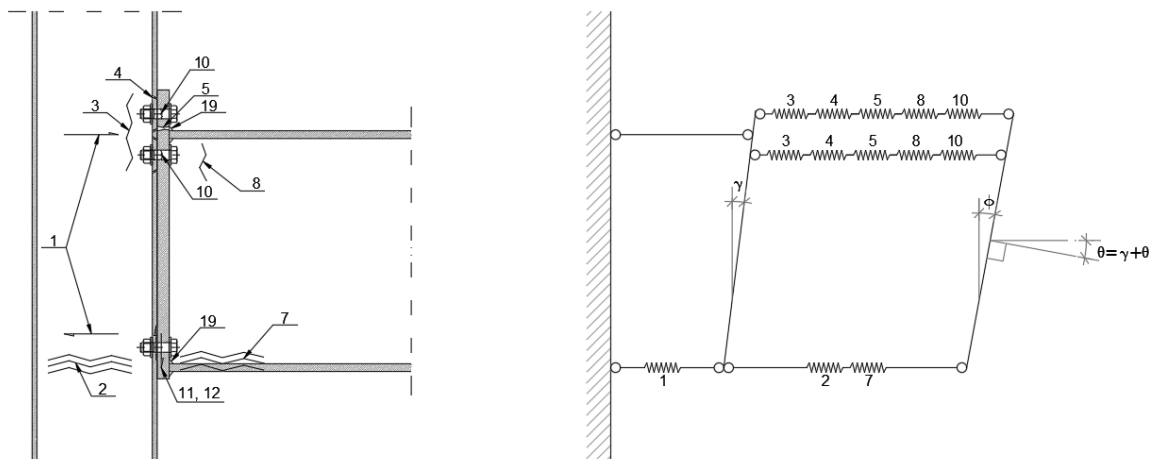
Identificação de componentes activos e modelo idealizado da junta de ligação viga/coluna
